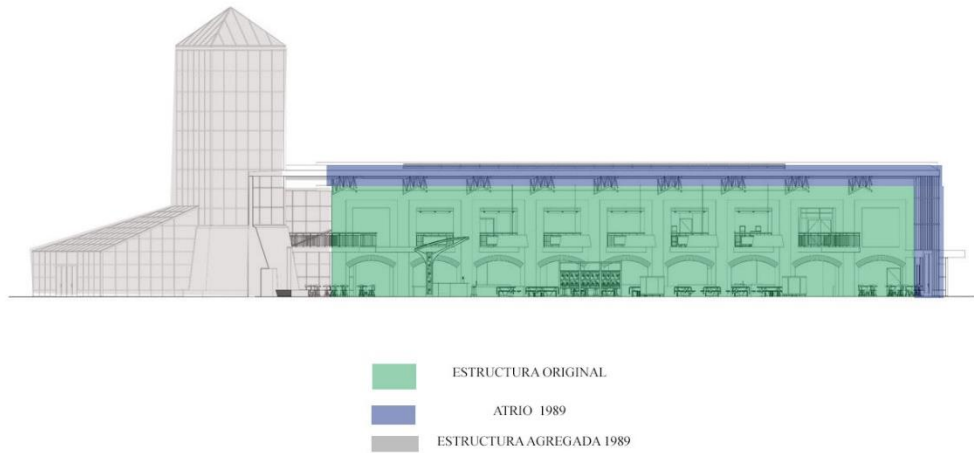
Estructuras del Mercado Forks. Fuente: ArchDaily
